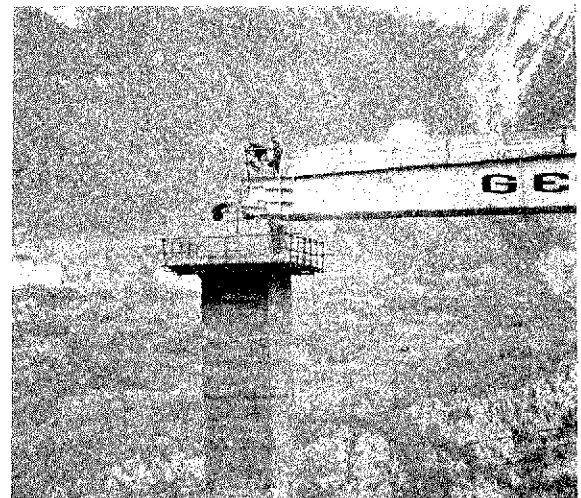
Encuentro del pescante metálico con una de las pilas del puente.
